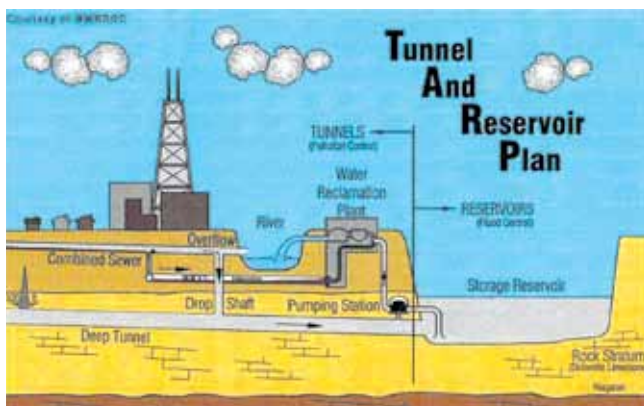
Схема работы системы TARP (Tunnel and Reservoir Plan)
